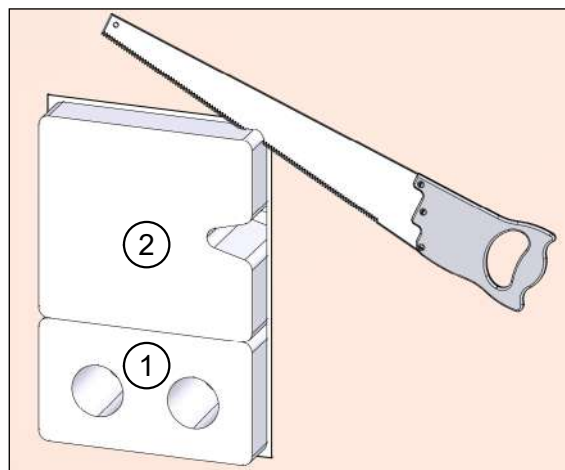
Modifica della cassetta a muro con elemento di riempimento
